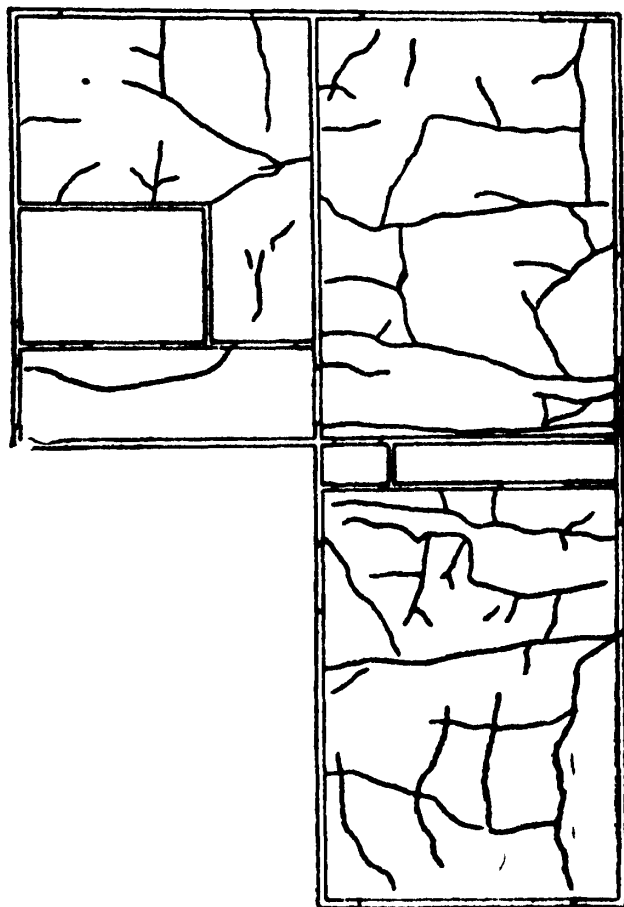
Трещины в прокатных панелях перекрытий
